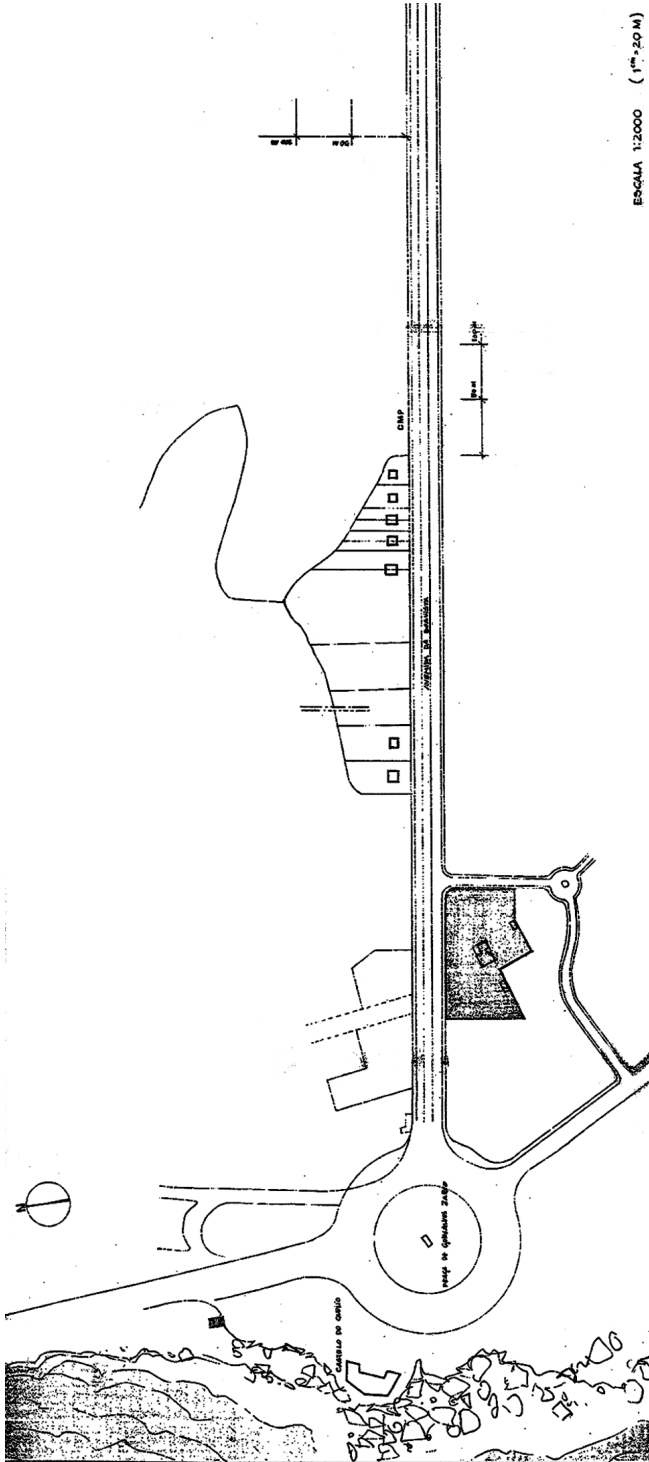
Planta da Avenida da Boavista. Instalação da sede do MNCT na cidade do Porto?, 1972? (Arquivo MNCT)
